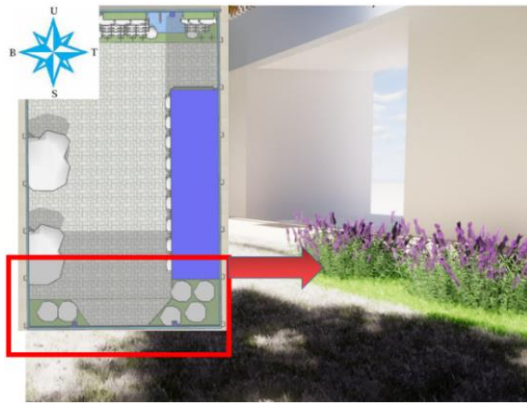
Siteplan dan Detail (*Point of Interest*) (Sumber: penulis).
